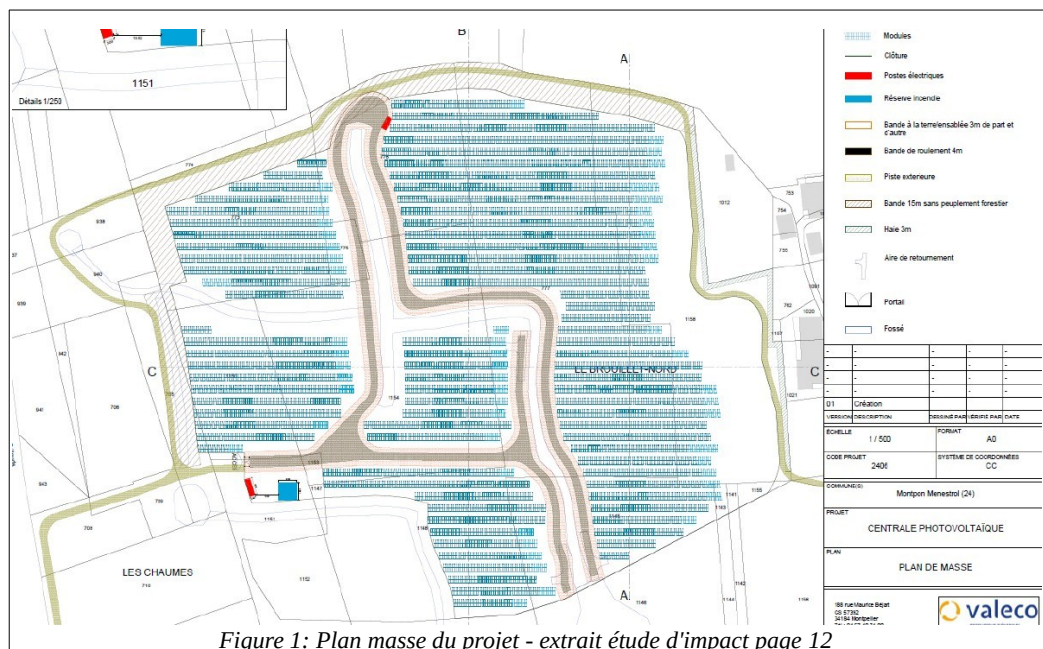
Plan masse du projet - extrait étude d'impact page 12
